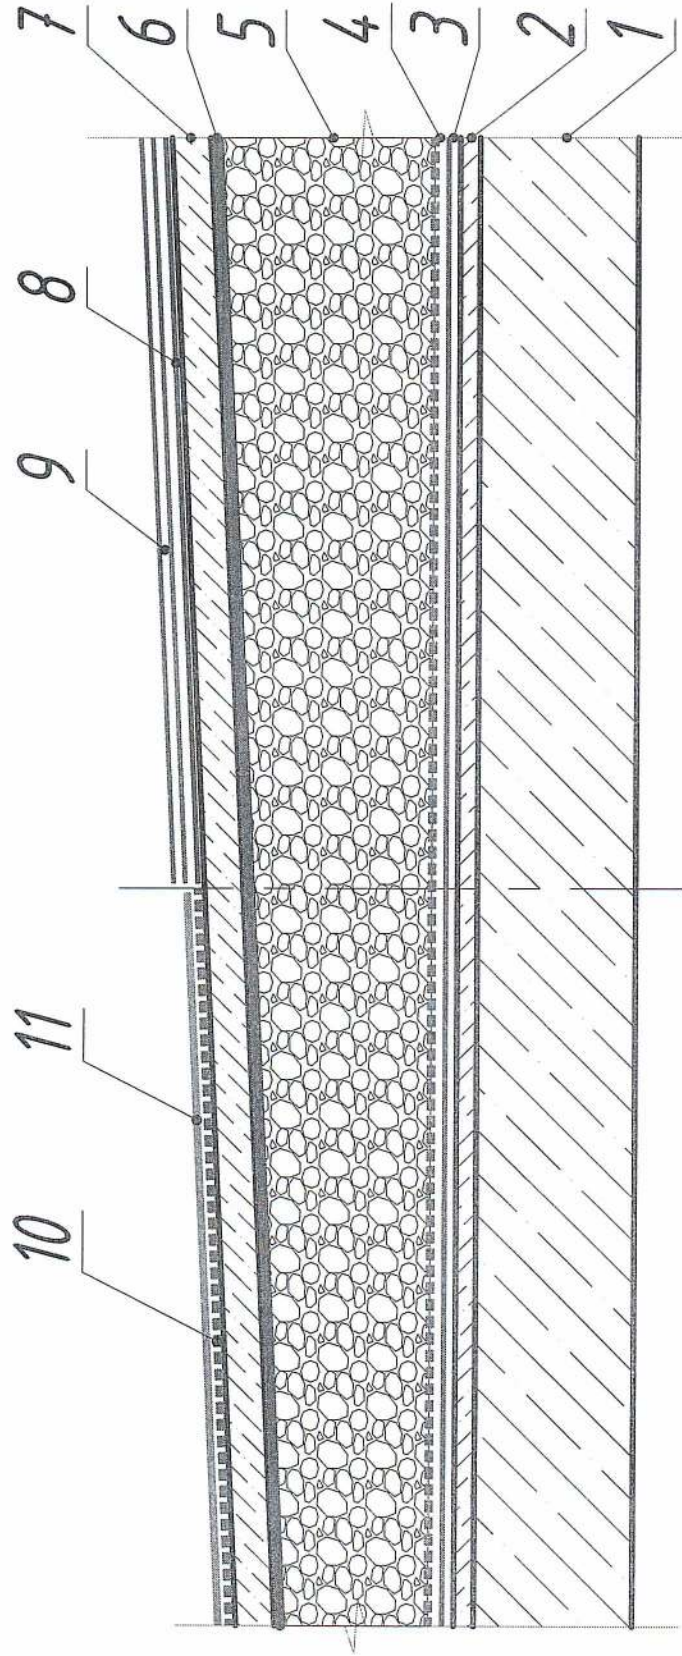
Принципиальная схема конструктивного исполнения настила бесчердачного покрытия выполняемого по железобетонному основанию (неэксплуатируемая кровля)
